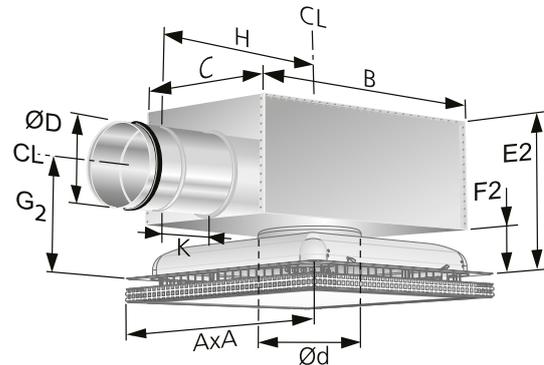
Dimensions, PELICAN Ceiling faible avec ALS faible.
